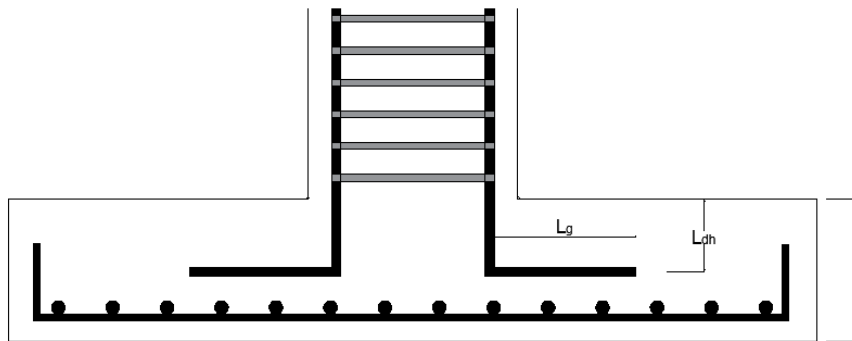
63 Detalle constructivo para ganchos a 90° de pedestales.
